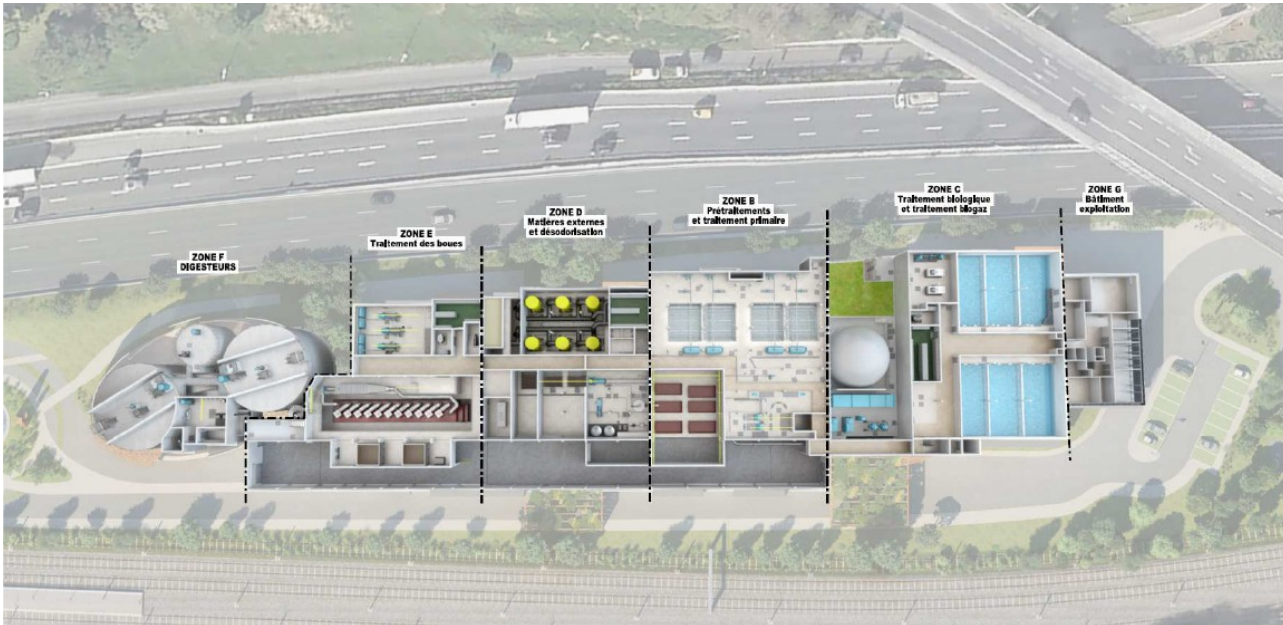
Plan des zones de traitement (source : présentation du site, page 10)
